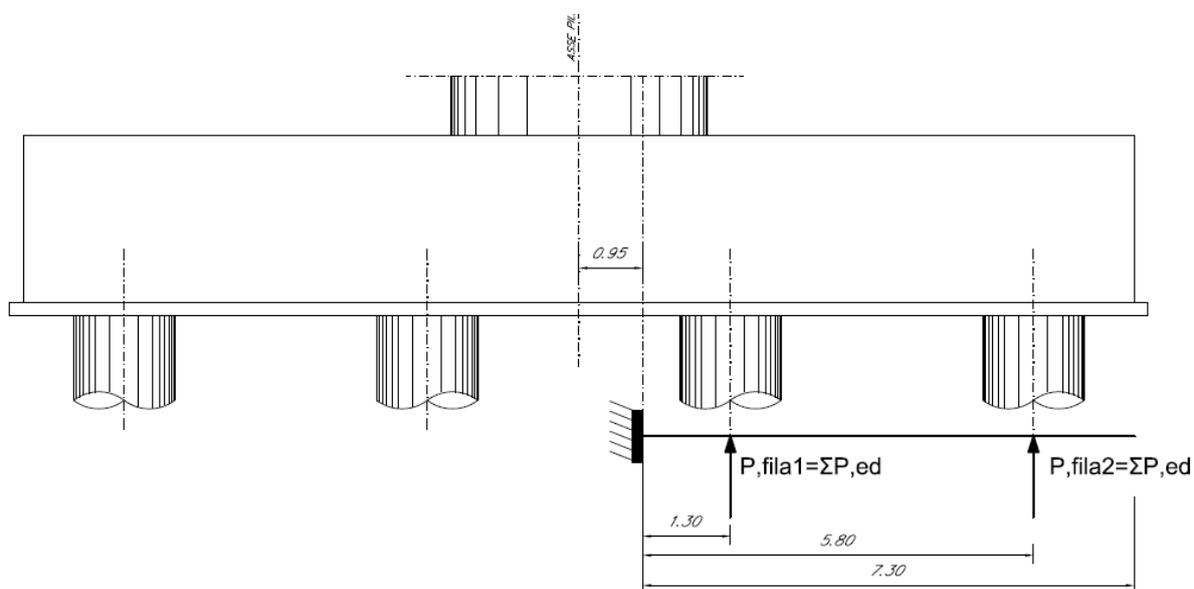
Modello a mensola longitudinale del plinto di fondazione
